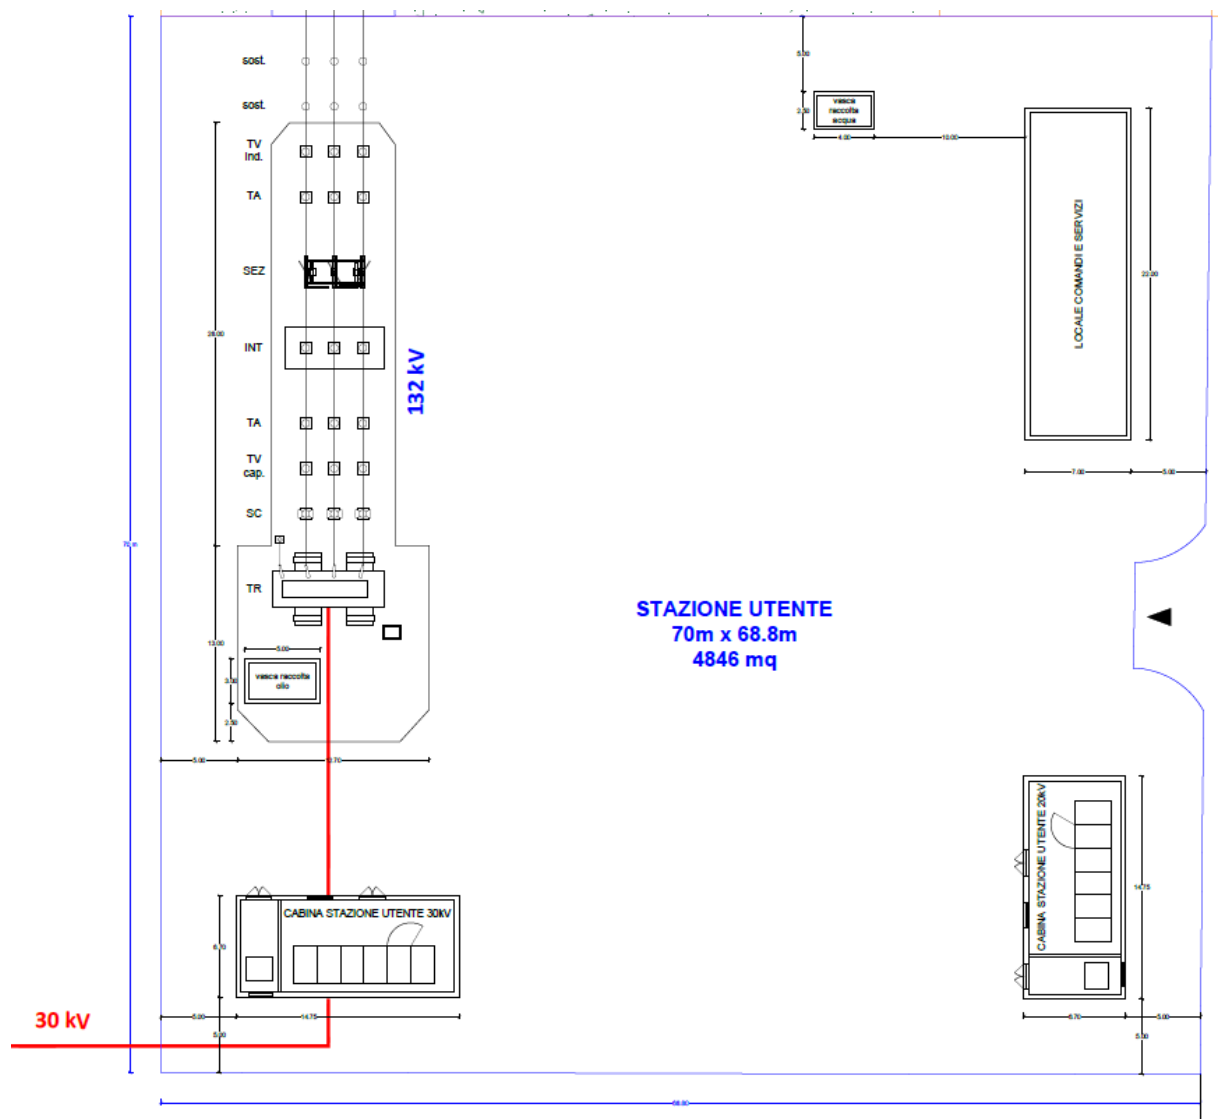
pianta Stazione Utente presso CP E-Distribuzione “Mezzolara”.
